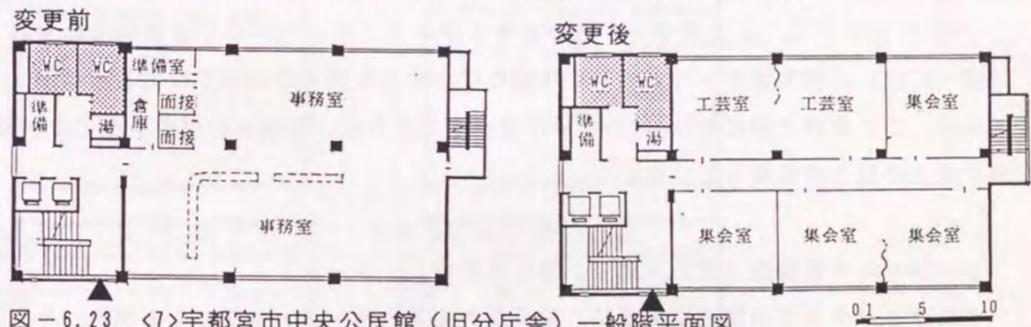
<7>宇都宮市中央公民館（旧分庁舎）一般階平面図
